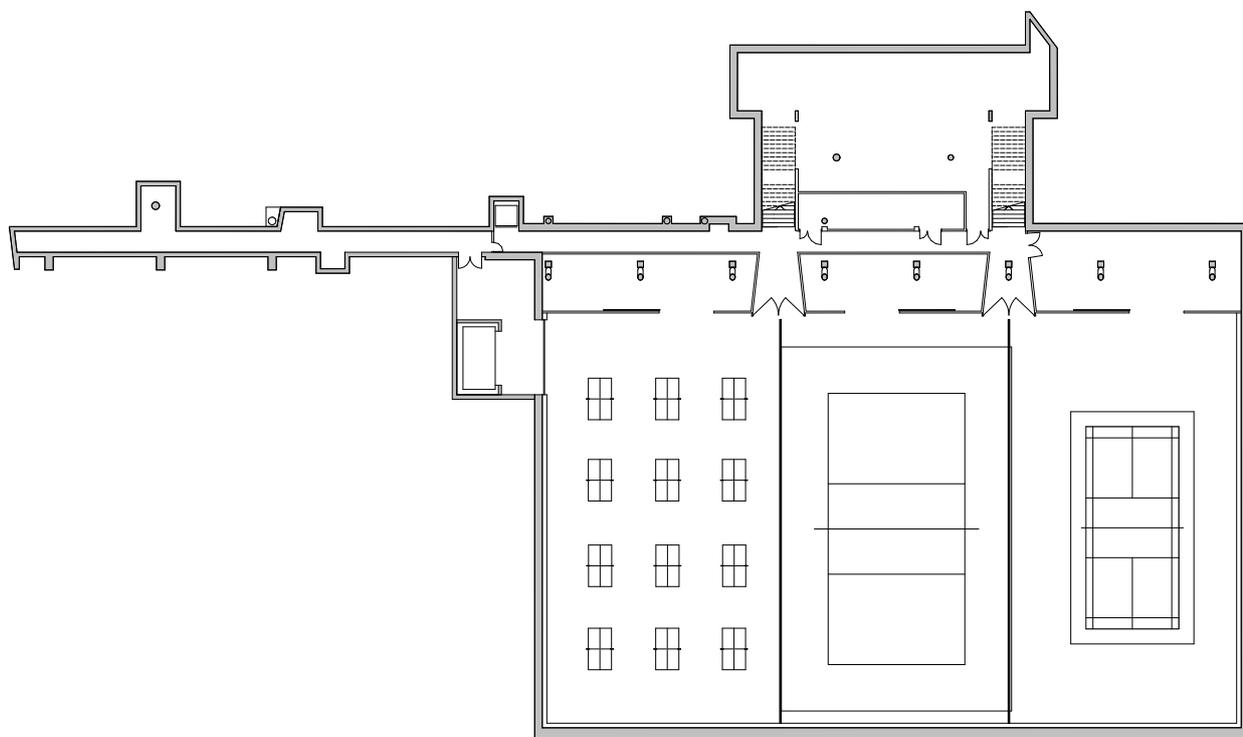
Grundriss 2.UG - Dreifachturnhalle
